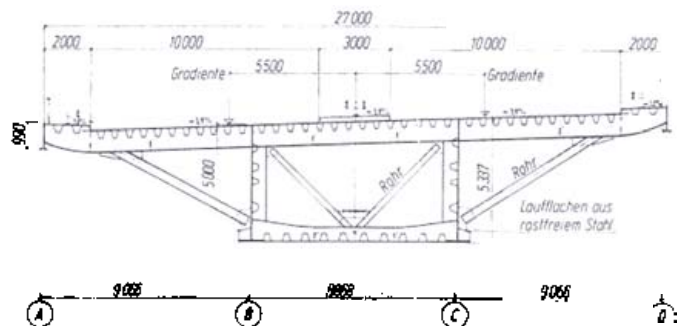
Querschnitt mit Streben der Sauertalbrücke
